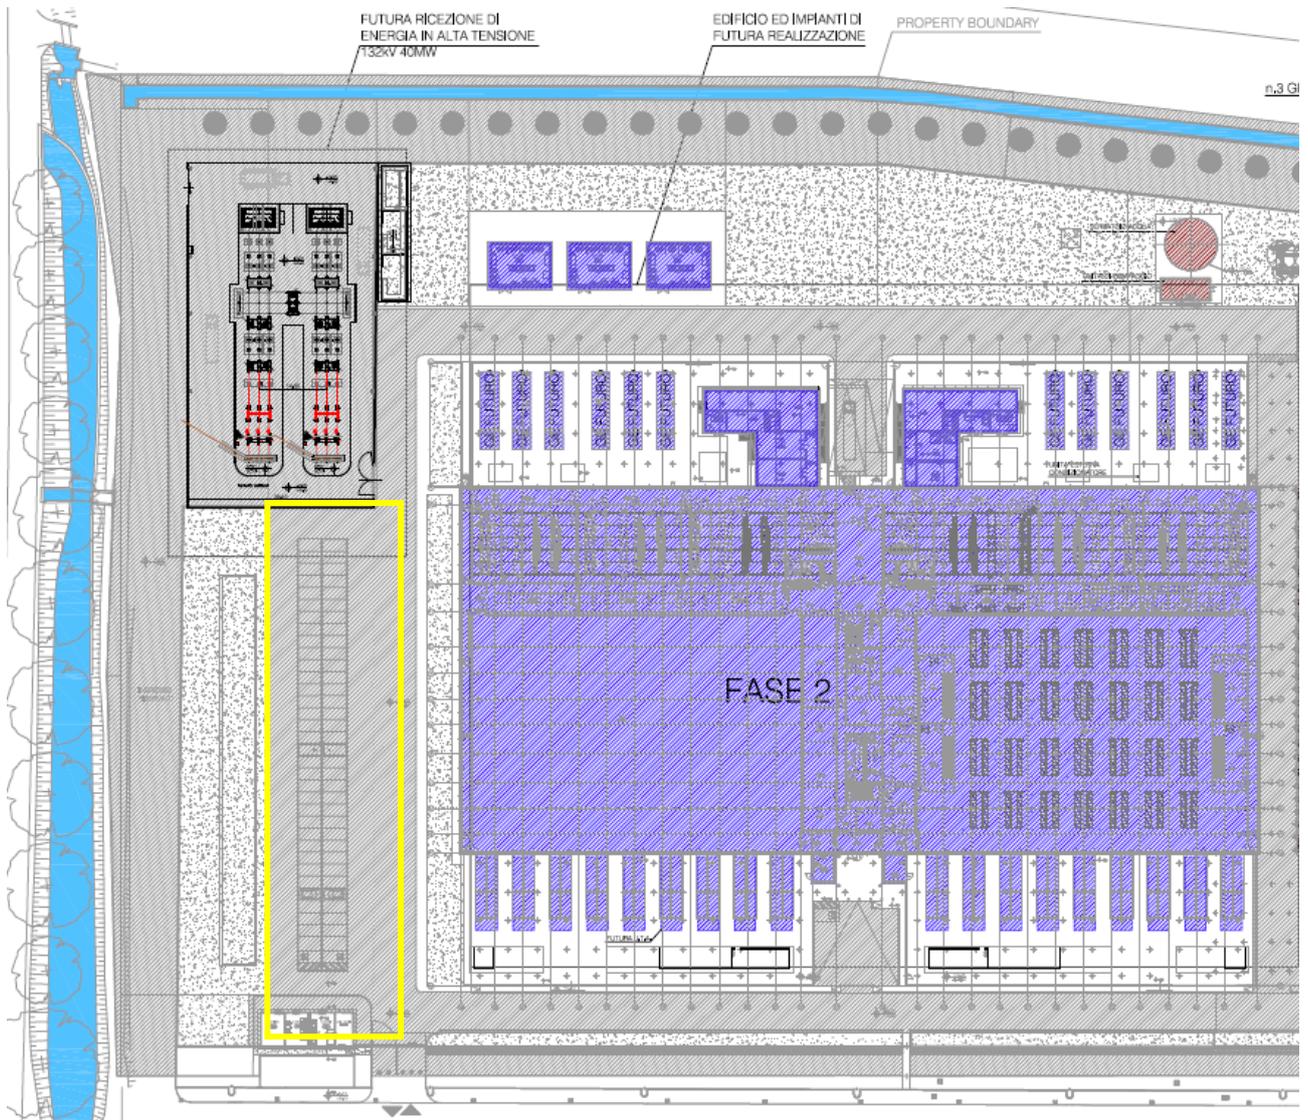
estratto da "EE001 – Planimetria dell'Officina Elettrica" con dettaglio mod. 2 (impianto fotovoltaico in giallo)
